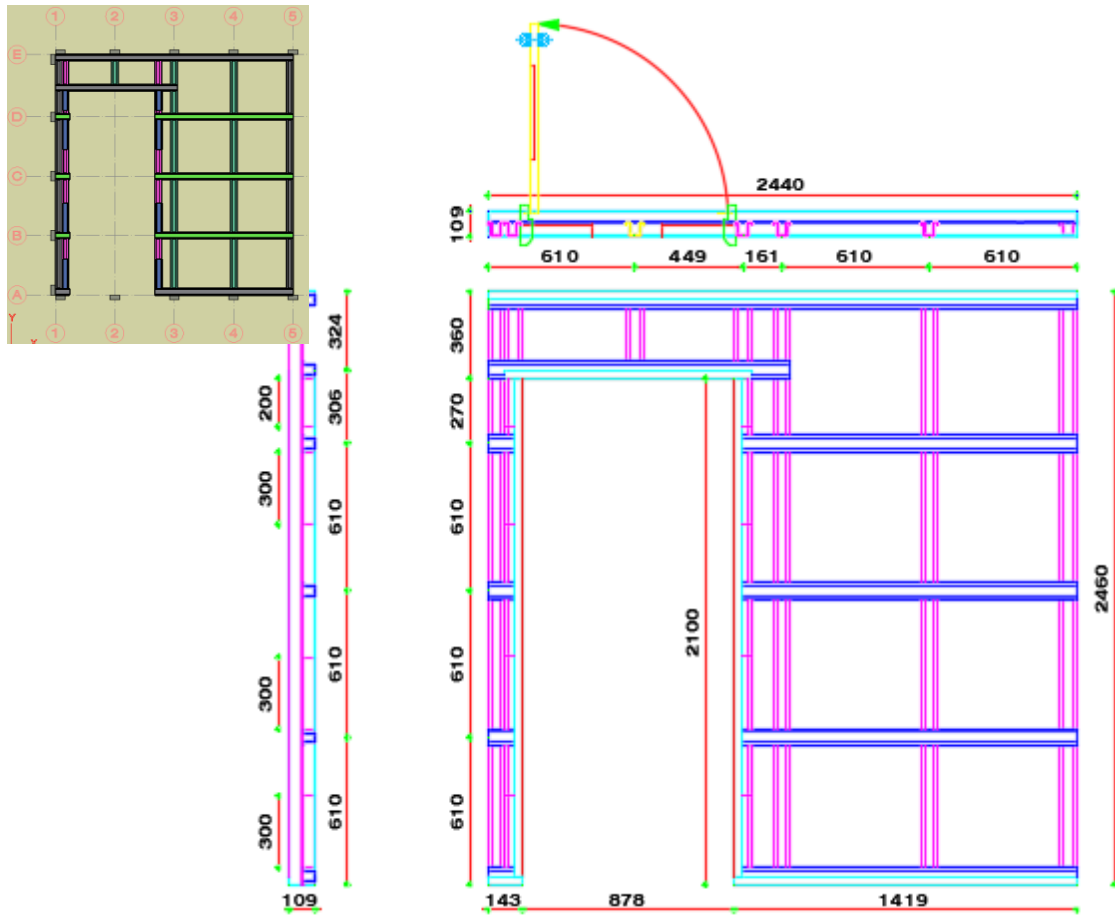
Dimensiones de panel puerta de 2.440mm x 2.460mm
